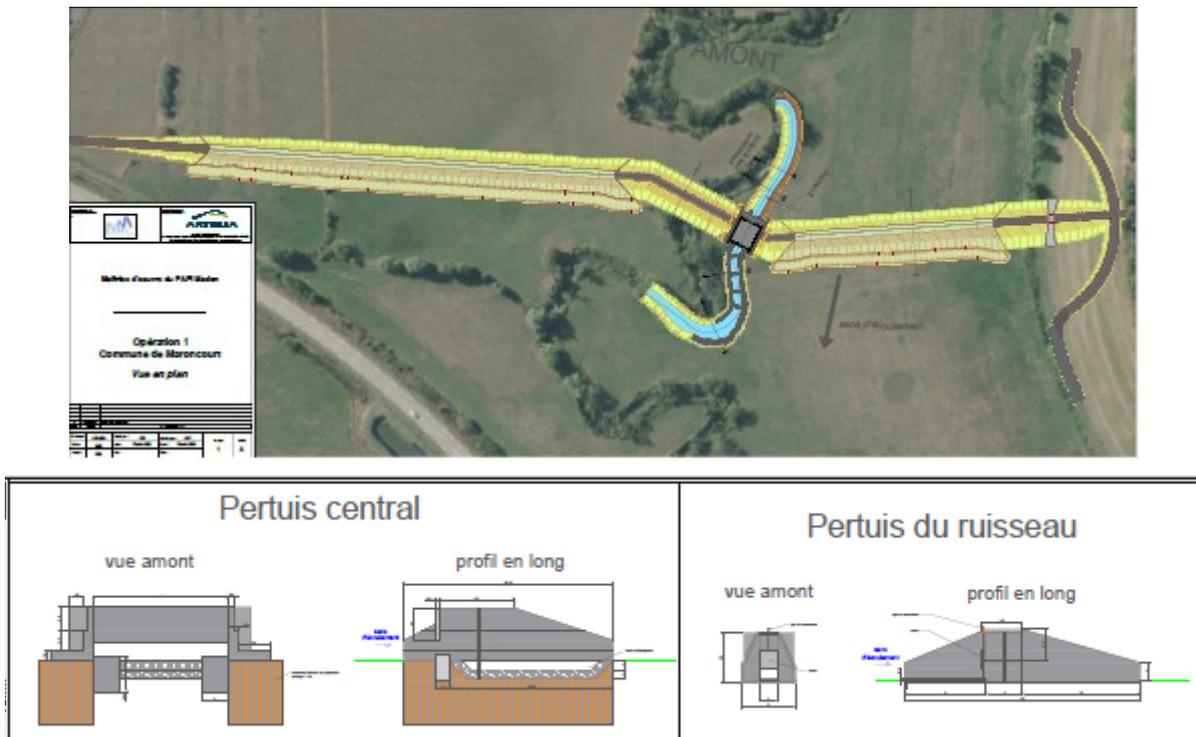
Plan de l’ouvrage ZRDC et des pertuis
